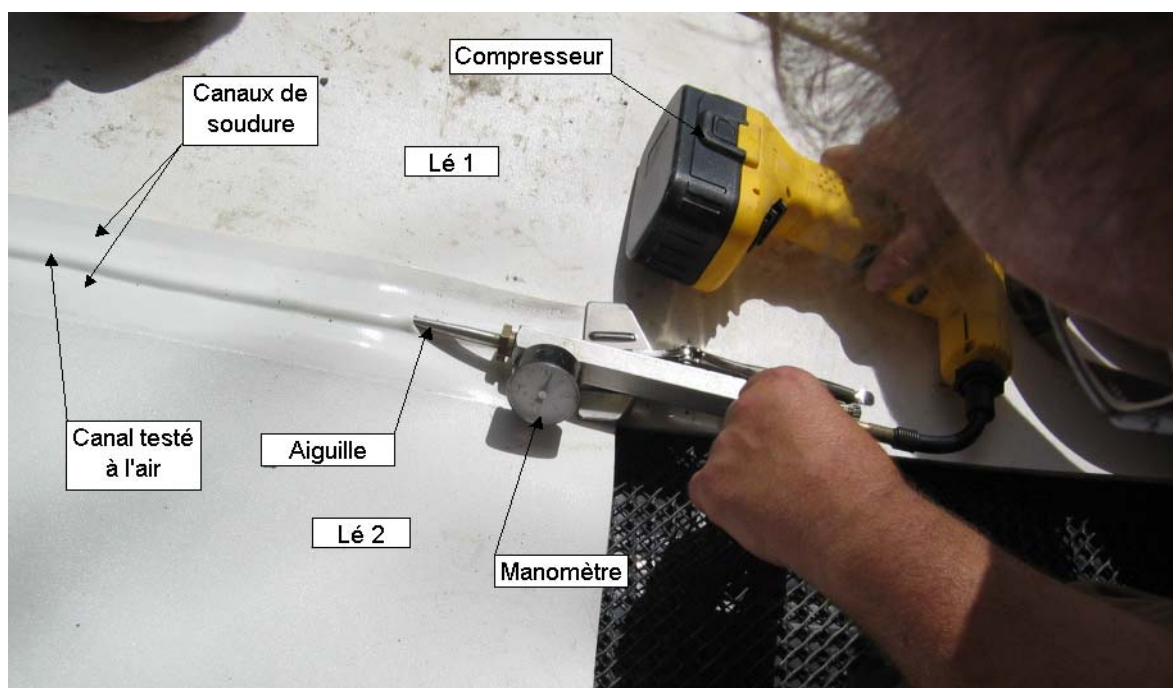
Essai à l'air comprimé d'une soudure sur membrane PVC
